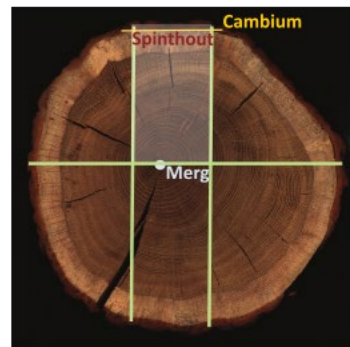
Twee, drie tot vierzijdig gerechte balk uit derde uit halve stam
